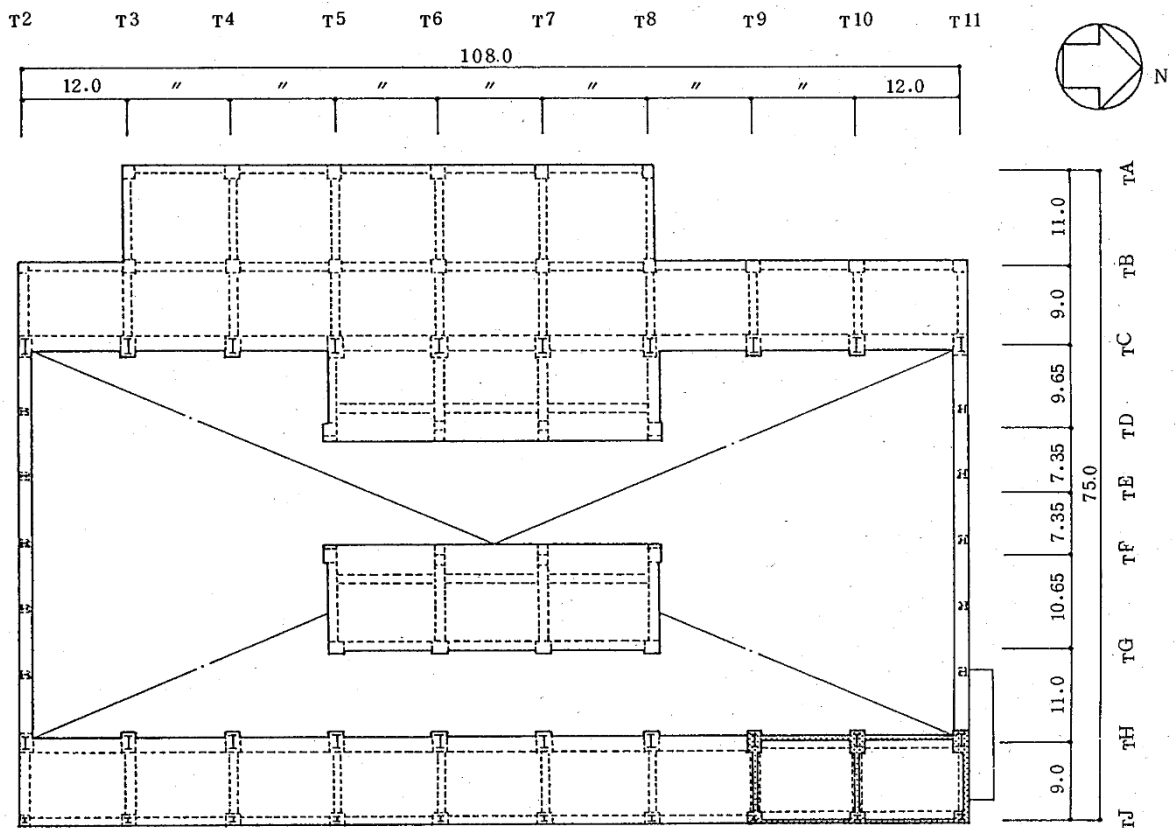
概略平面図 (T. M. S. L. 31.6m)
